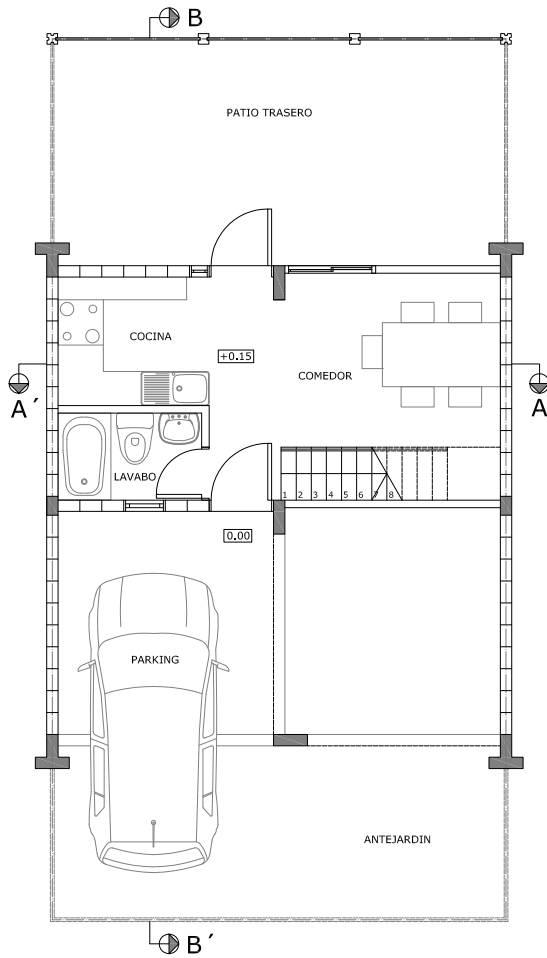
Cambio del sistema constructivo del proyecto básico al proyecto ejecutivo
